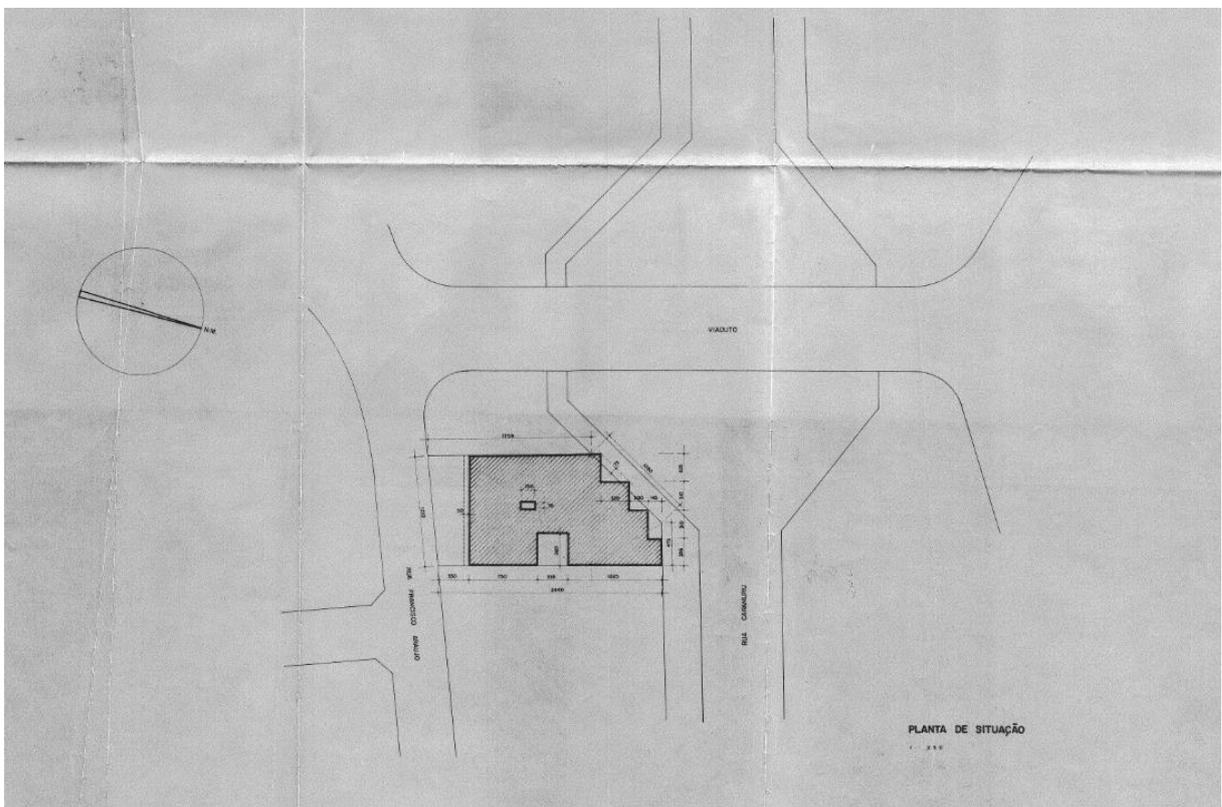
Planta de situação do Ed. Souza Antunes, destacando o perfil irregular do terreno e sua inserção em um lote disposto entre duas vias.
